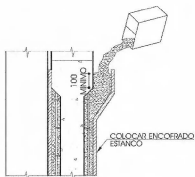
Instalación de Moldaje de Columna y Hormigonado.
